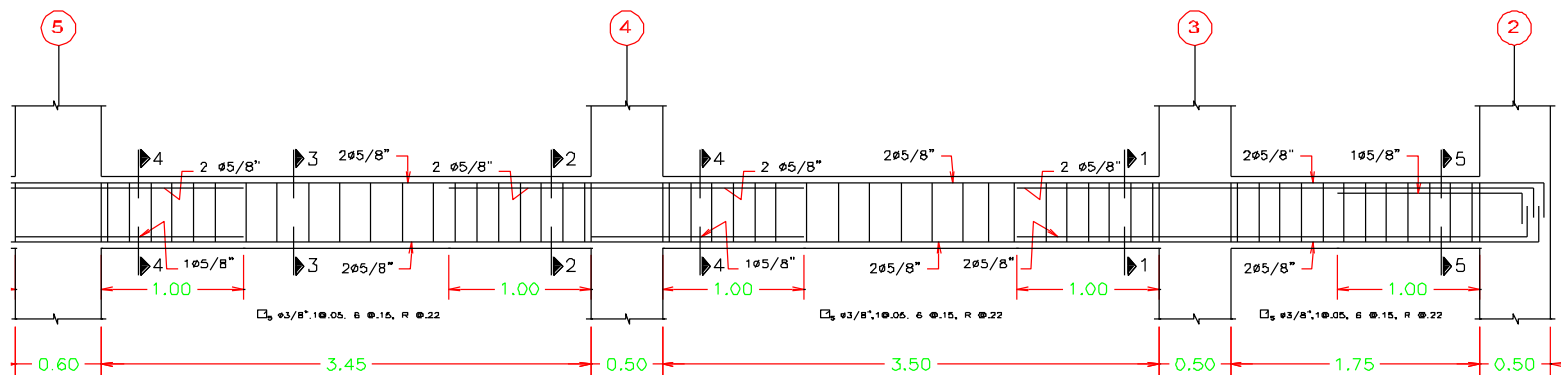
Detalle del acero de refuerzo para la viga principal del BLOQUE 1.
